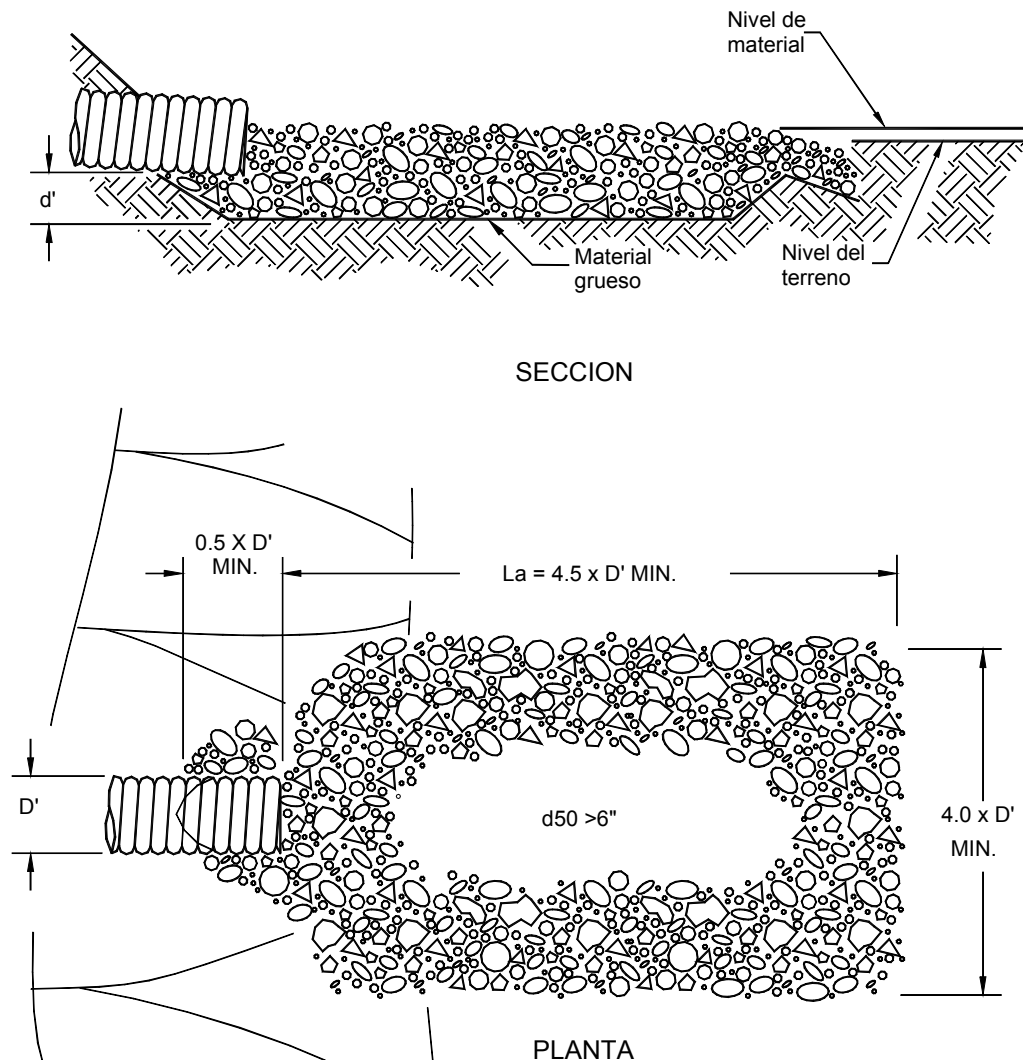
Protección con enrocado en la entrega de una alcantarilla o canal (McCullah, 2001).
